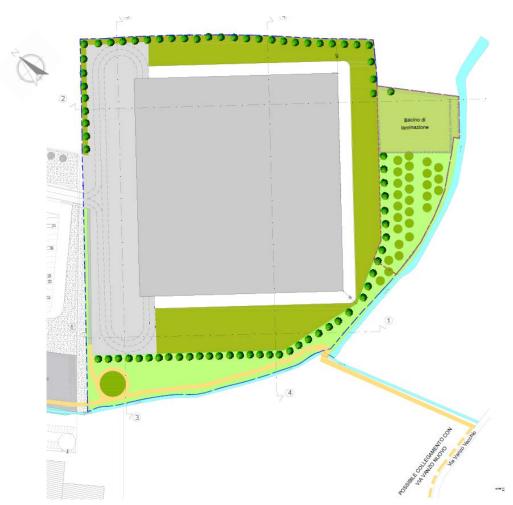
Planimetria generale dell'ambito oggetto di trasformazione
